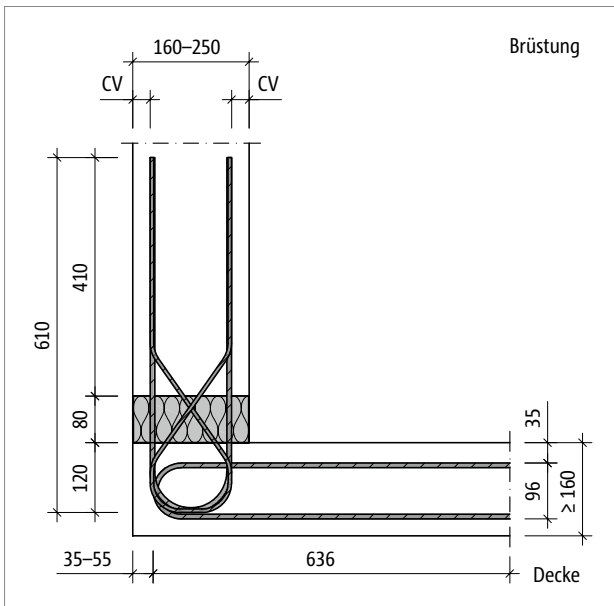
Schöck Isokorb® T Typ A-MM2-X80: Produktschnitt
